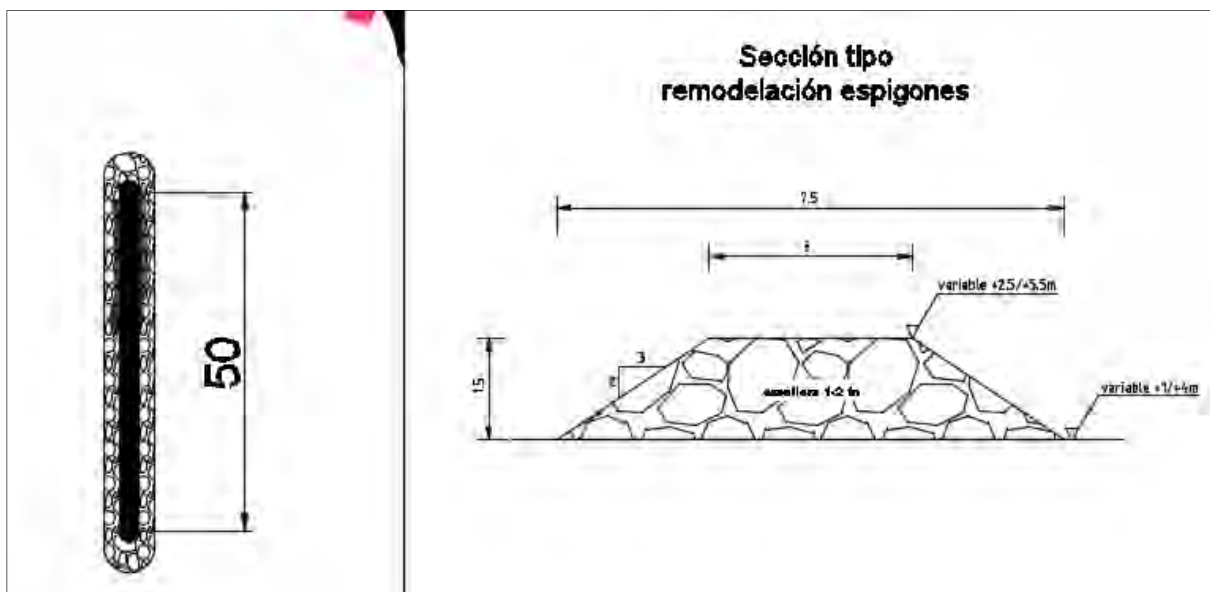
Detalle del recrecimiento de los espigones. Planta y perfil tipo
